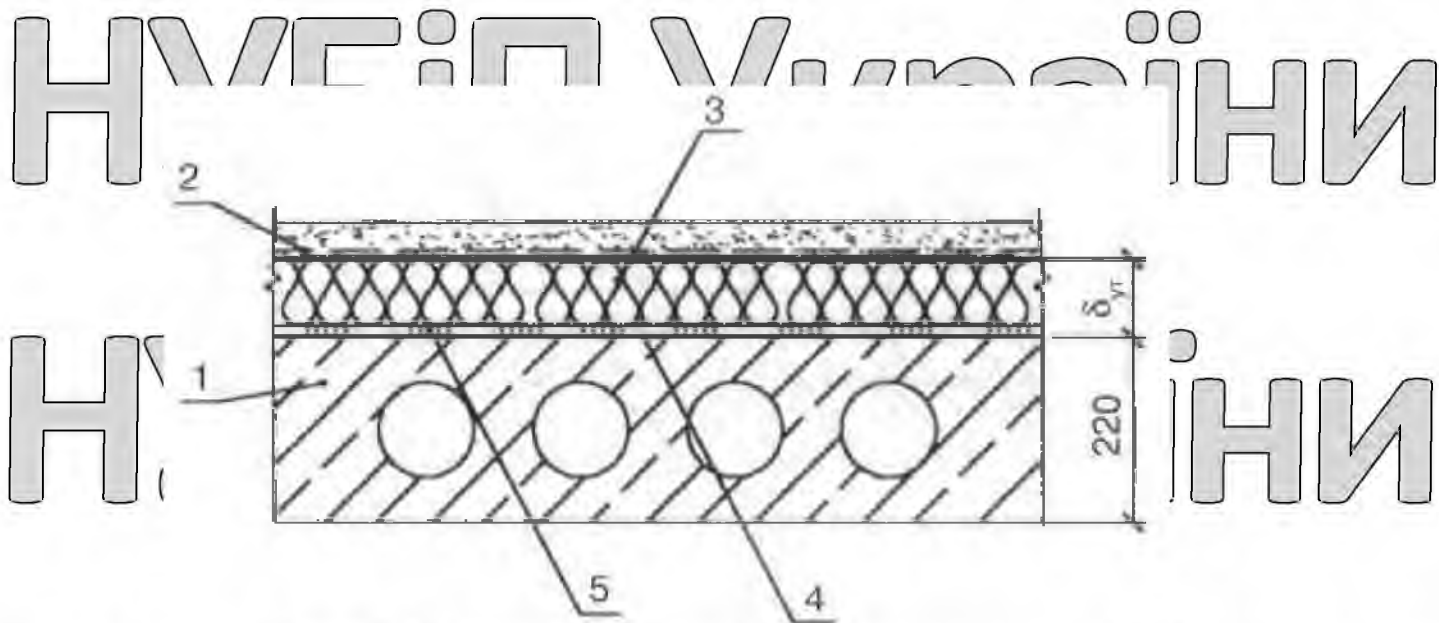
Схема утеплення підлоги першого поверху над холодним підвалом: 1 – перекриття залізобетонне; 2 – армована цементно-піщана стяжка; 3 – плити теплоізоляційні тверді; 4 – пароізоляція; 5 – шар клею
